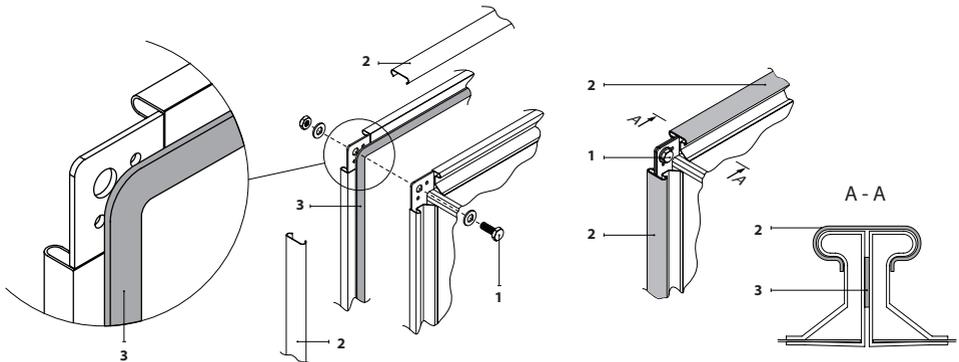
Exemple de fixation et d'étanchéité d'un raccordement de conduites à brides
